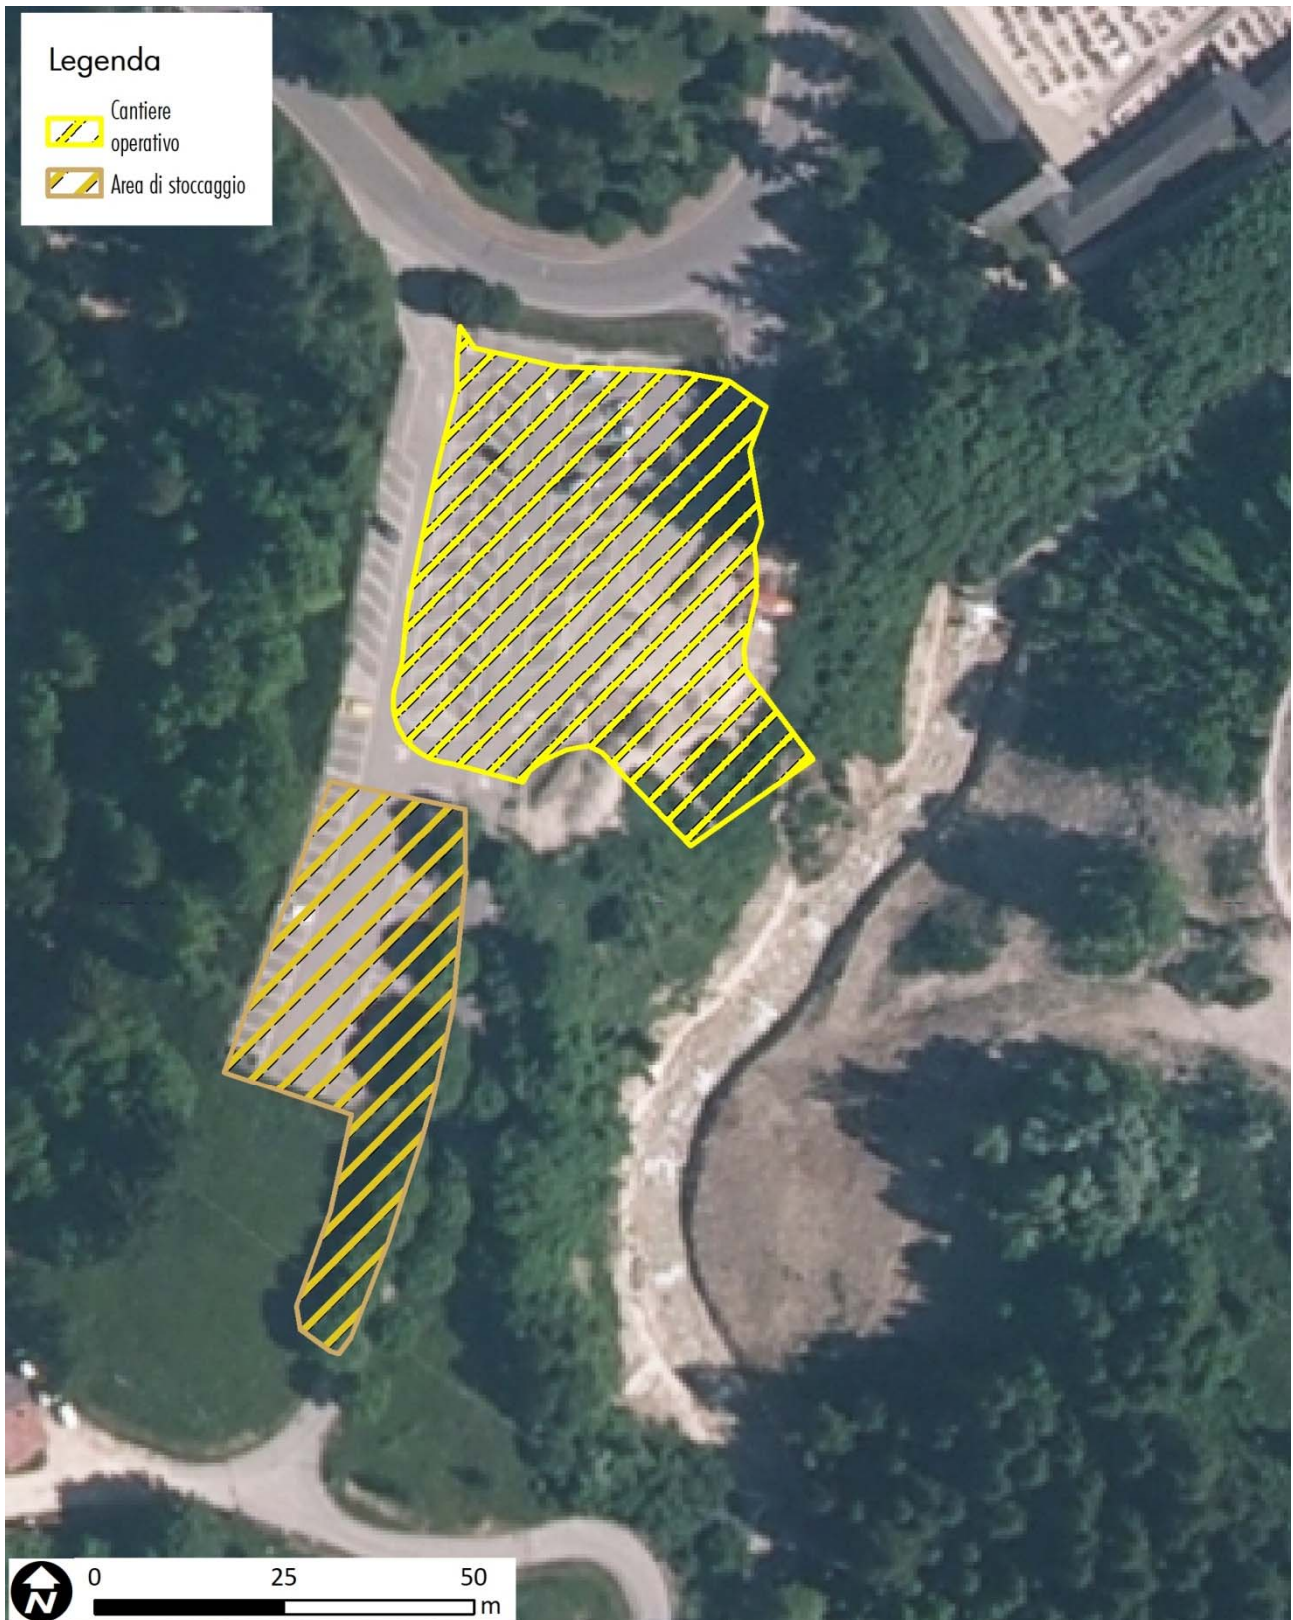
Particolare del cantiere operativo e area di stoccaggio.
